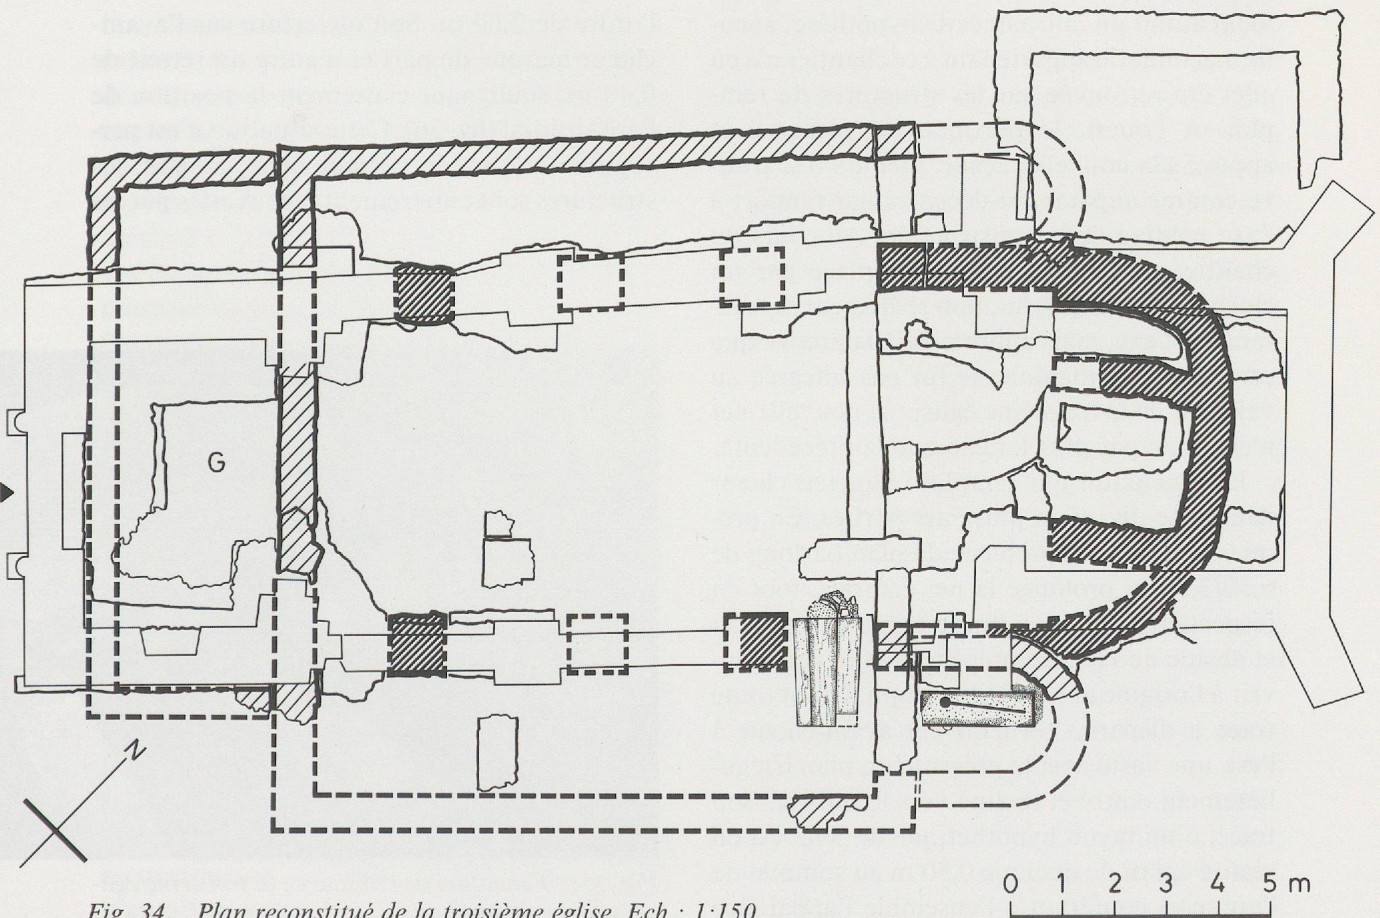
Plan reconstitué de la troisième église. Ech.: 1:150.
